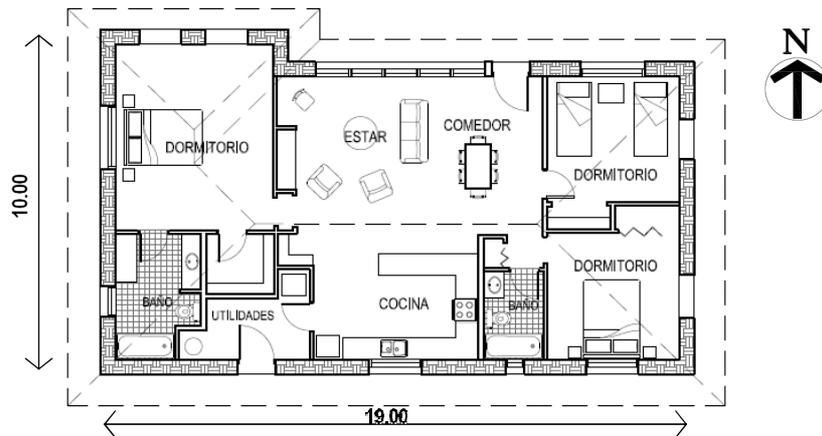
Planta del proyecto. (FUENTE: Arq. Touson Saryon of Integral Design Estudio, 1998)
